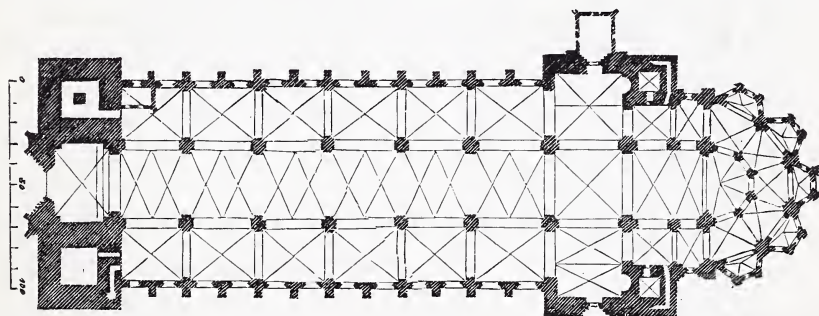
Grundriss des Domes zu Magdeburg.
